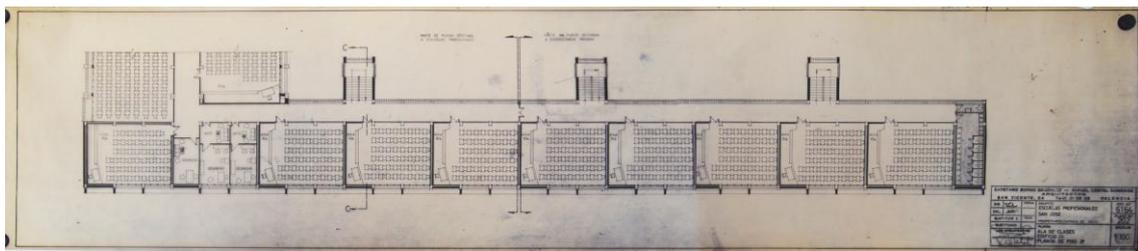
Planta clases. *Archivo Escuelas San José.
